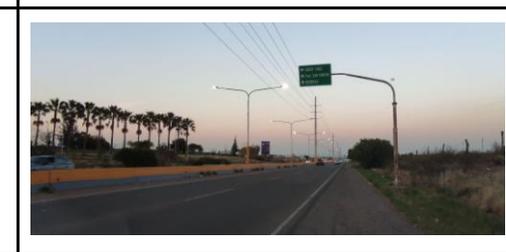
Vista SE - Desmontes realizados hacia el noreste del predio.
